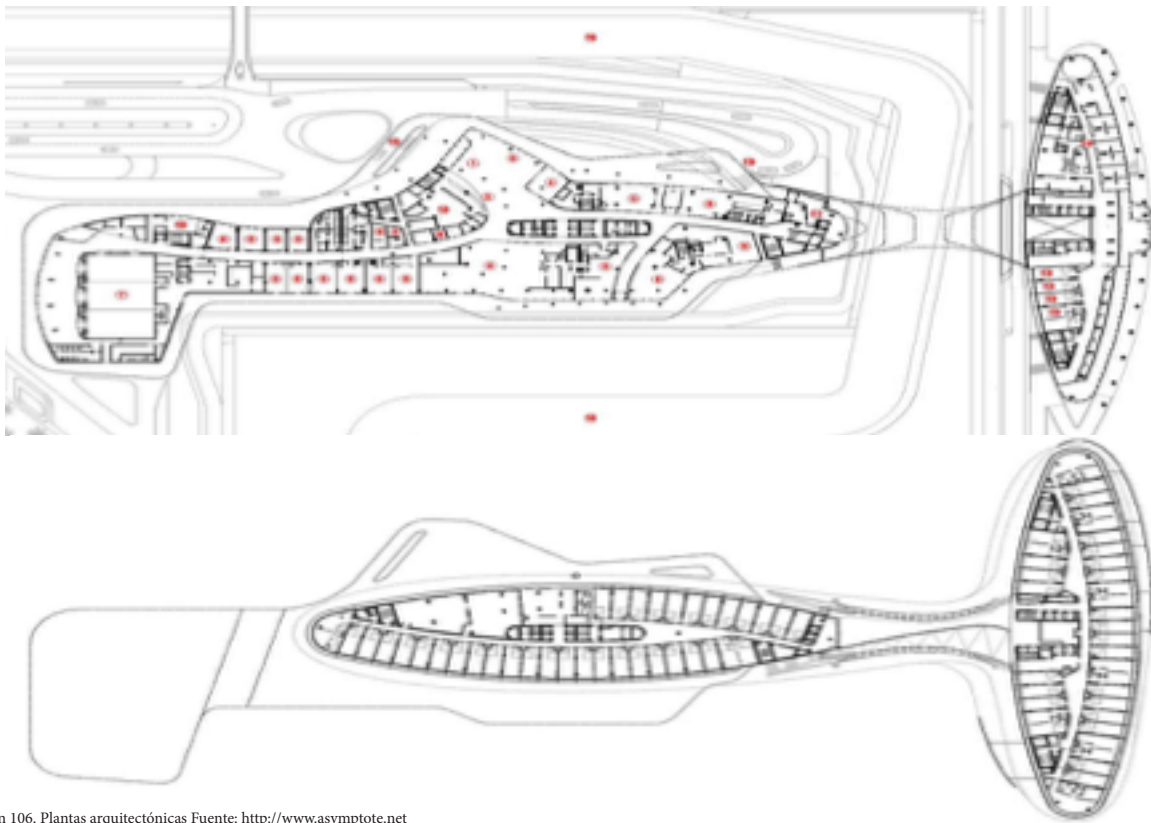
Plantas arquitectónicas Fuente: <http://www.asymptote.net>
